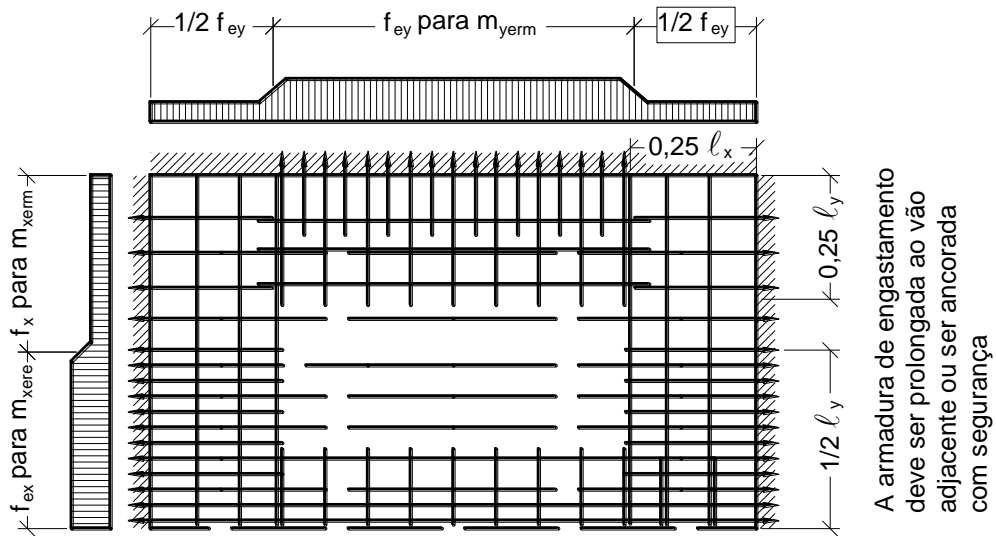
Armadura superior de laje retangular apoiada em três lados engastados com carga uniforme.
